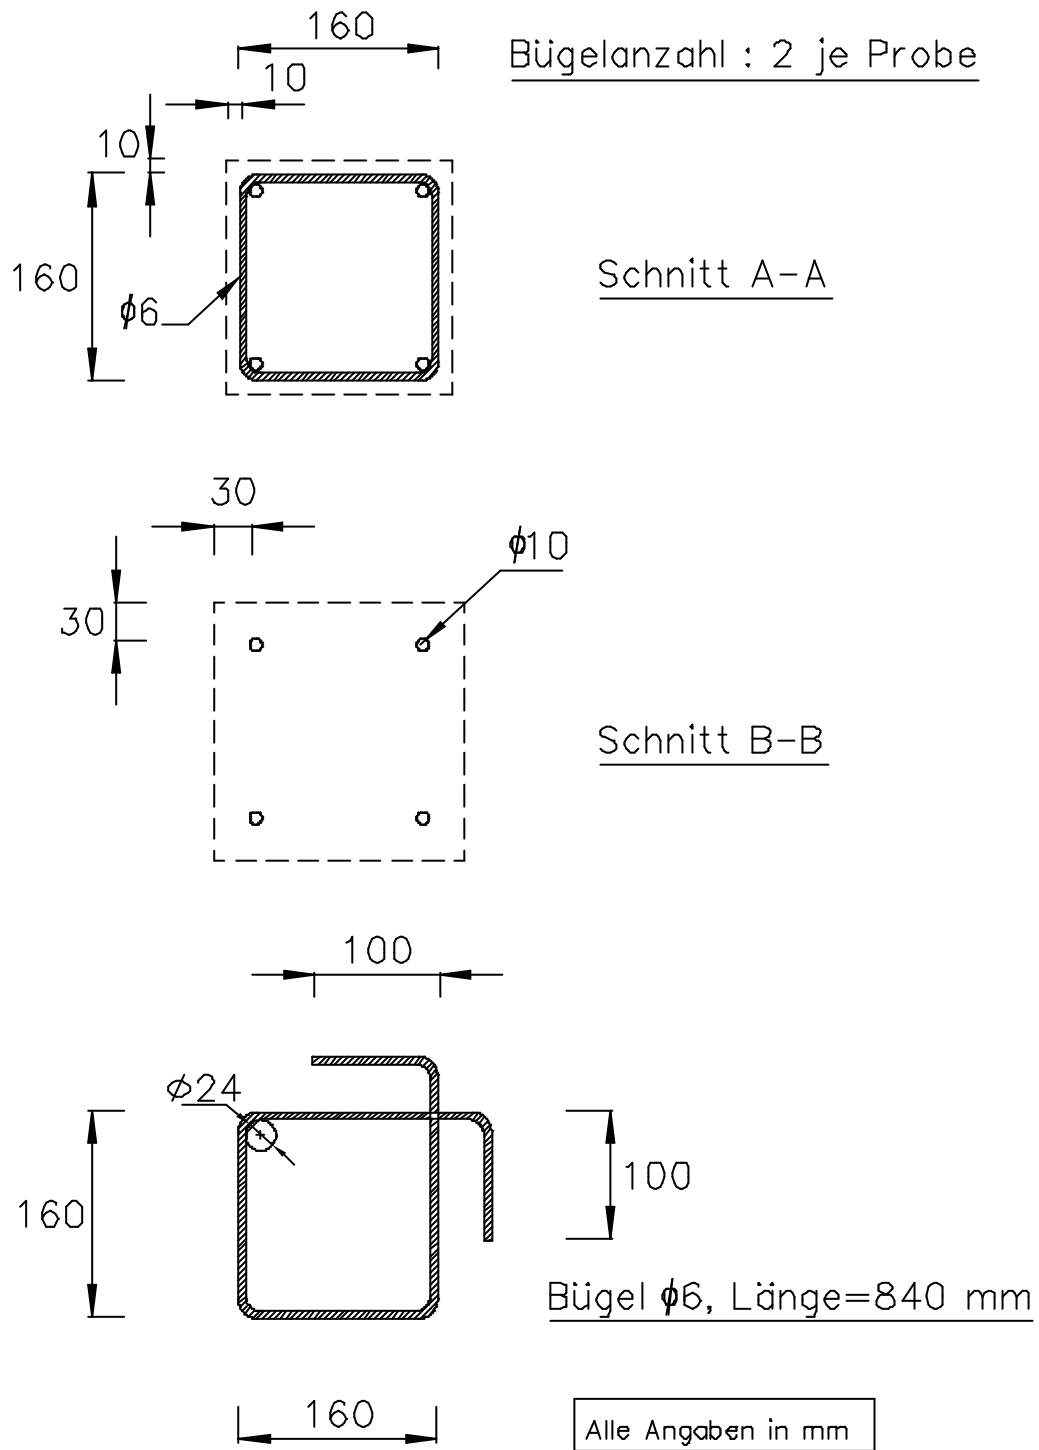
Der konstruktive Bewehrungskorb der Grundkörper, Bügel
